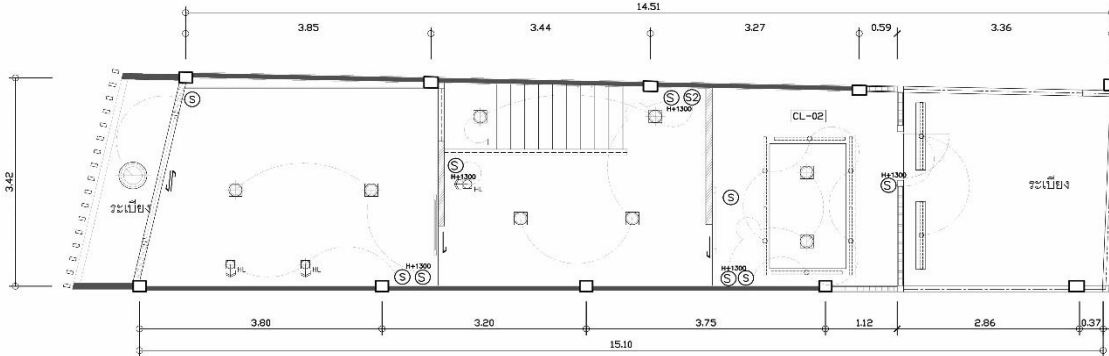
Furniture lay out plan & Zoning Floor 3rd
